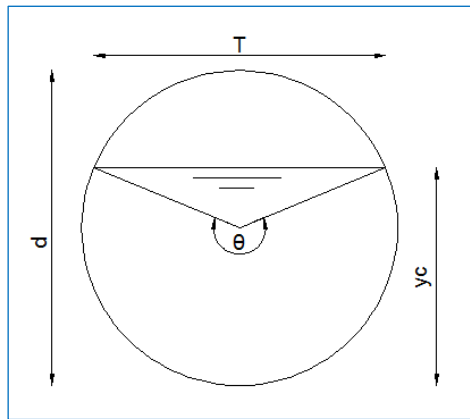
Elementos geometricos en una alcantarilla de seccion circular
